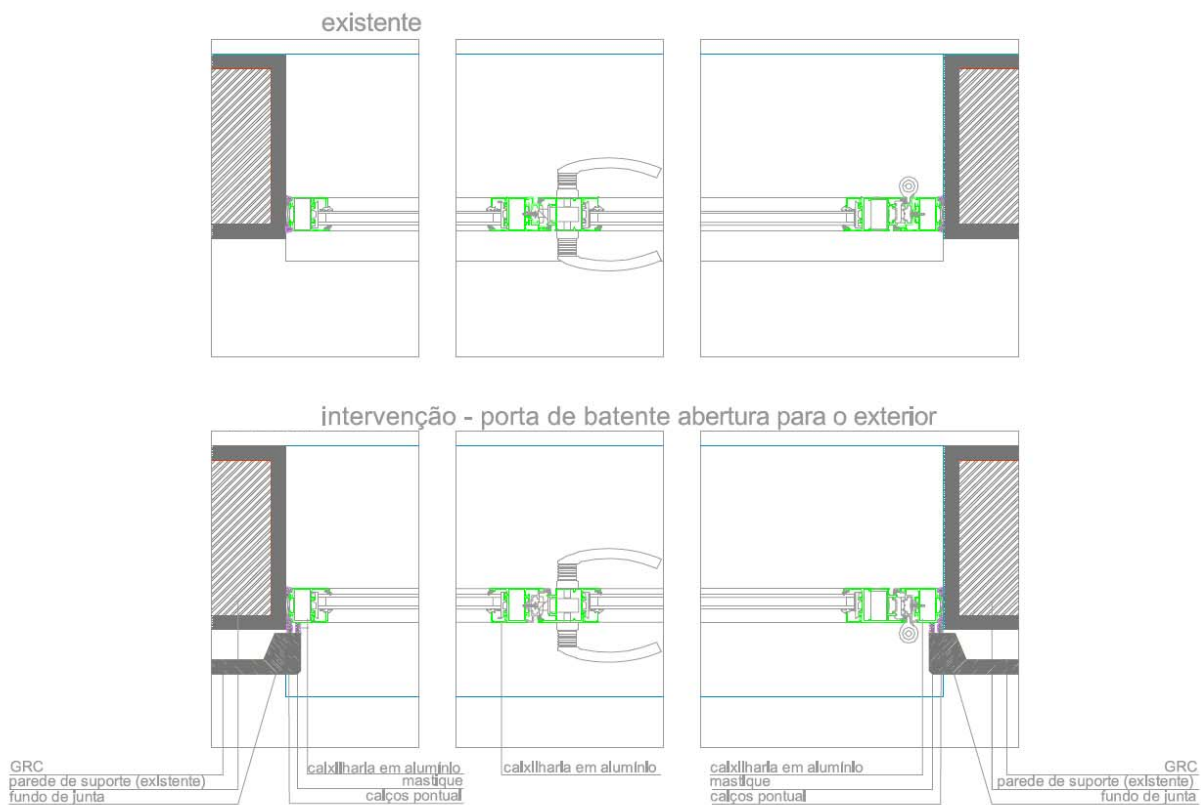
Pormenor construtivo horizontal. Entrada (escala 1/10).
